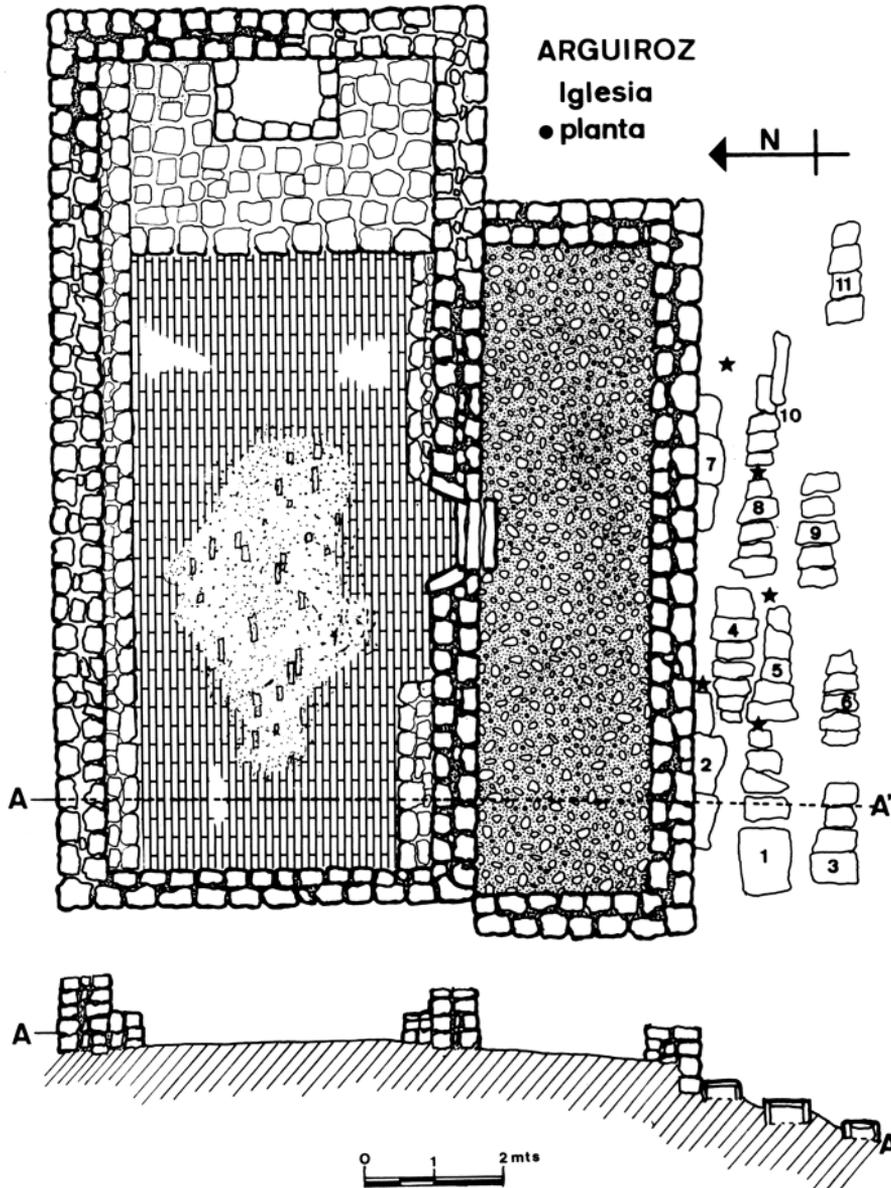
Planta de iglesia con cementerio anexo del despoblado medieval de Argüeroz.
